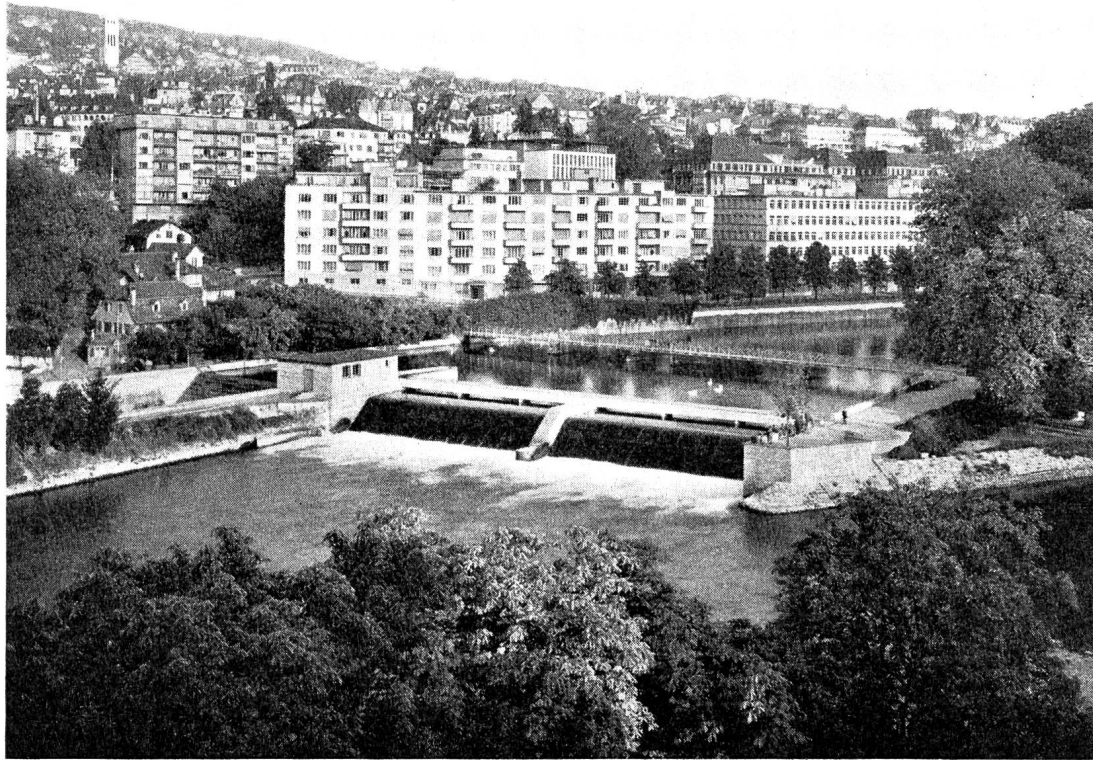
Hydraulische Dachwehrranlage beim Platzspitz
